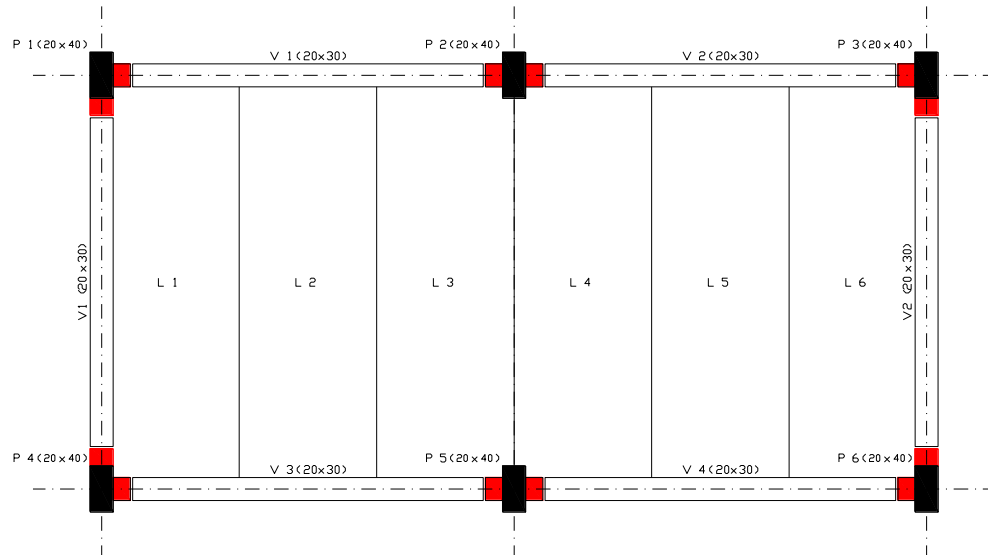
17 – Situação de distribuição desigual de lajes (sem recortes longitudinais).
